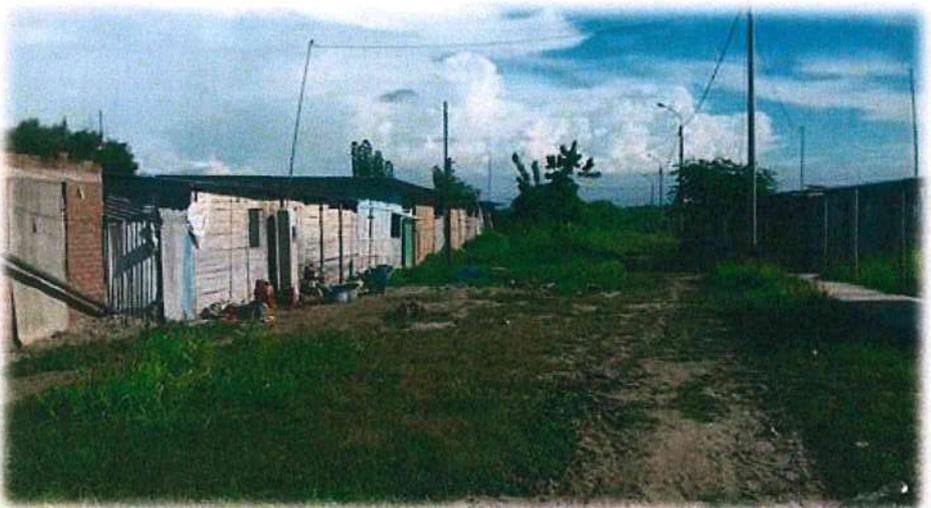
, 32, 33: Viviendas e infraestructura eléctrica afectada
